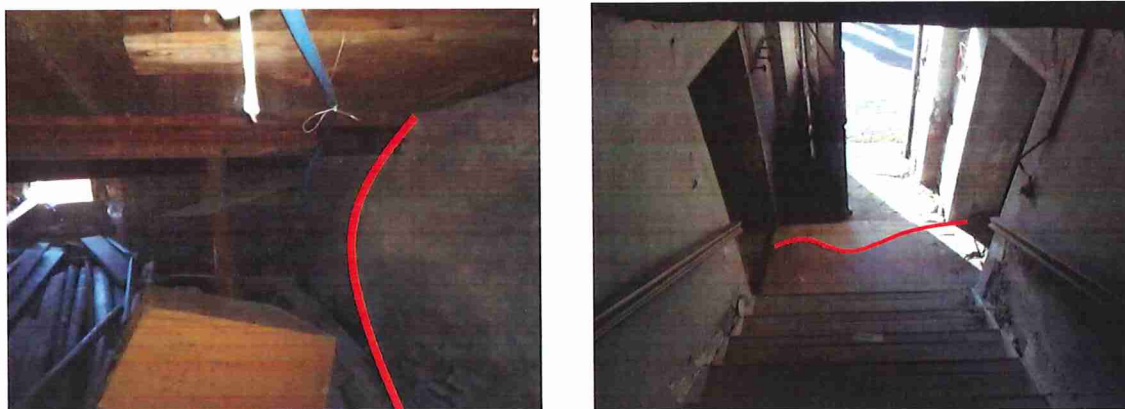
Bombement du mur enterré en amont à gauche et fissuration dallage à droite
